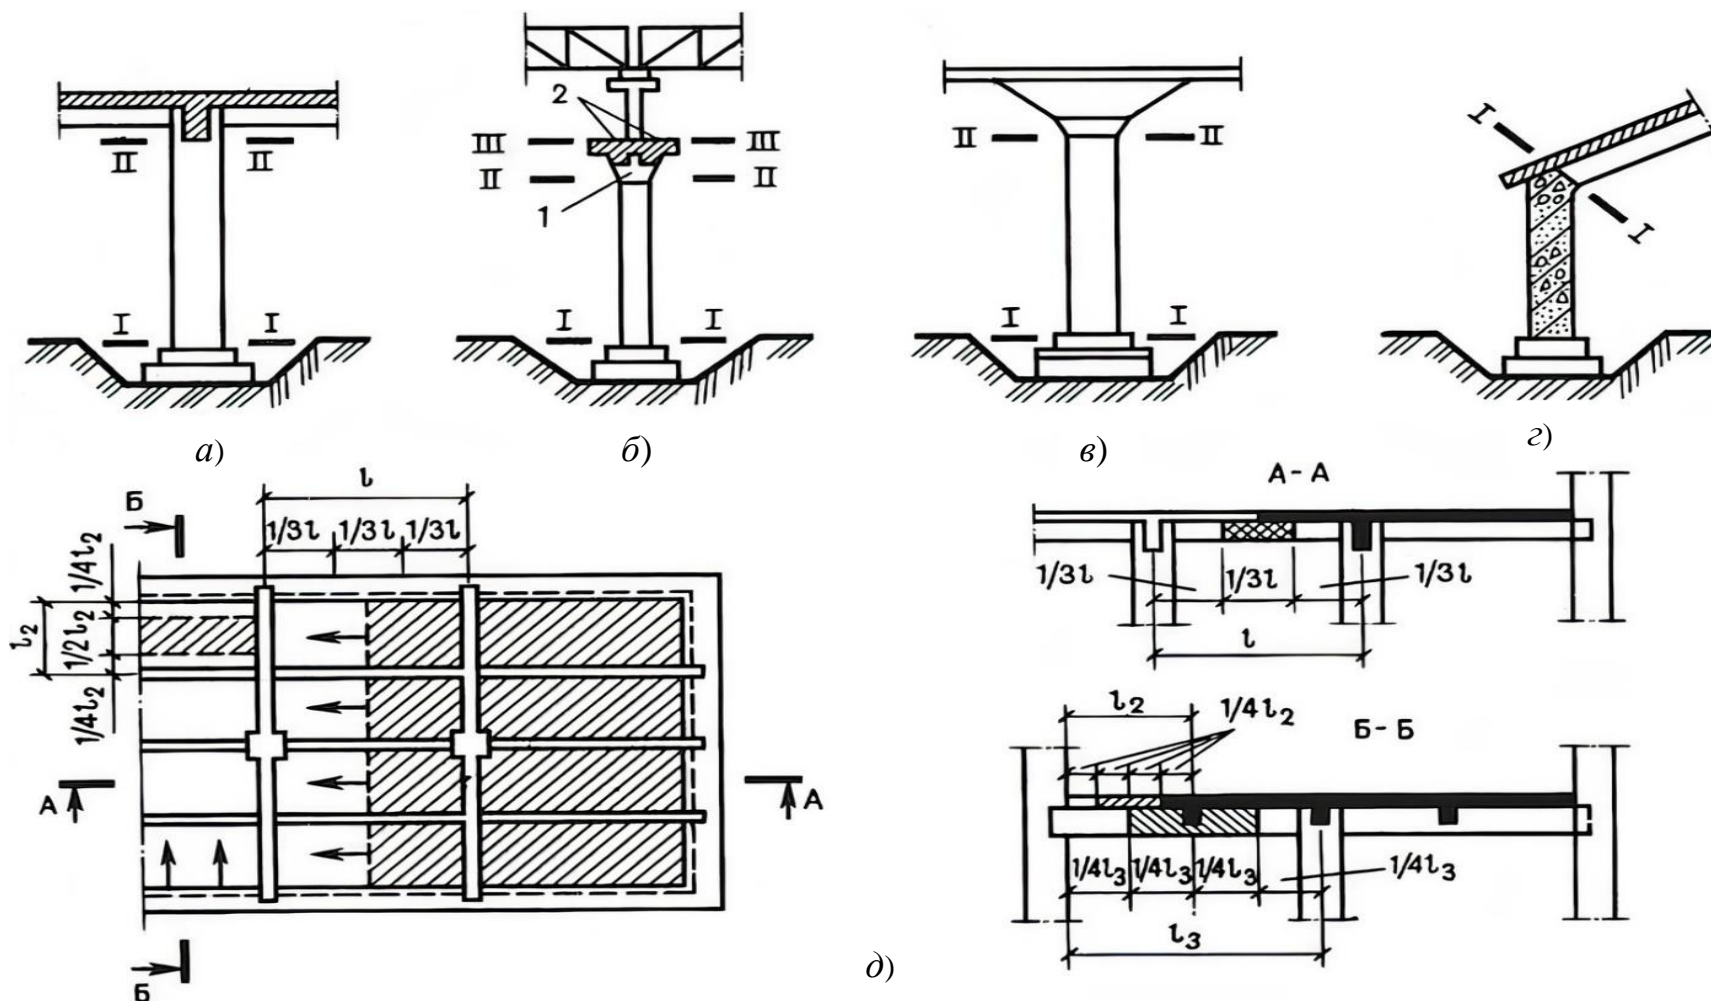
Места расположения рабочих швов в монолитных железобетонных конструкциях:
